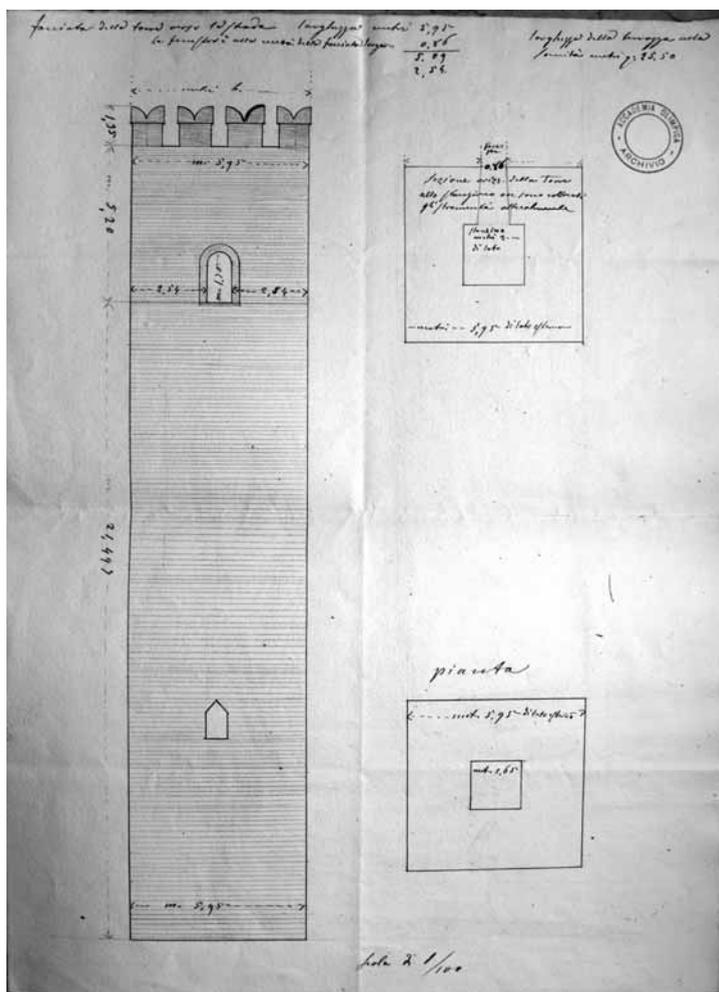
Pianta e prospetto della torre prima dell'installazione della custodia dei termometri
